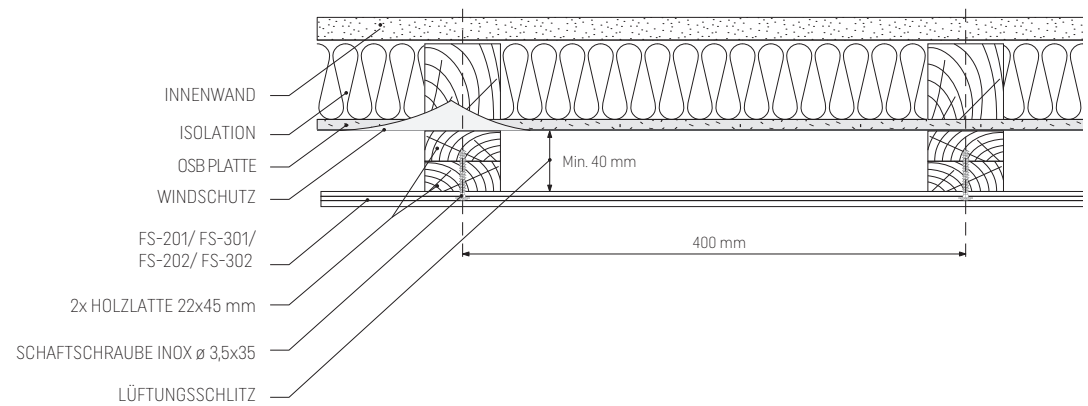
Lüftungsschlitz min. 20 mm, erforderlich bei Paneelen mit HELLEN, Gerüstkonstruktion - horizontaler Schnitt
